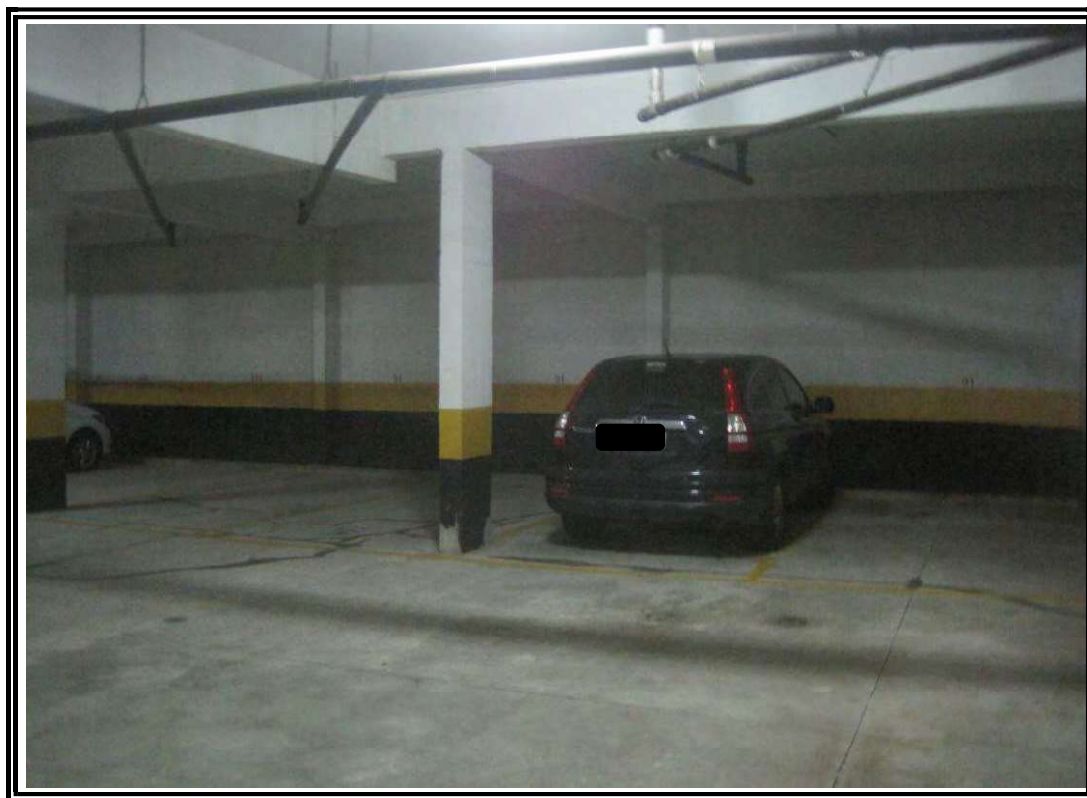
Detalhe das vagas de garagem (1º subsolo)
